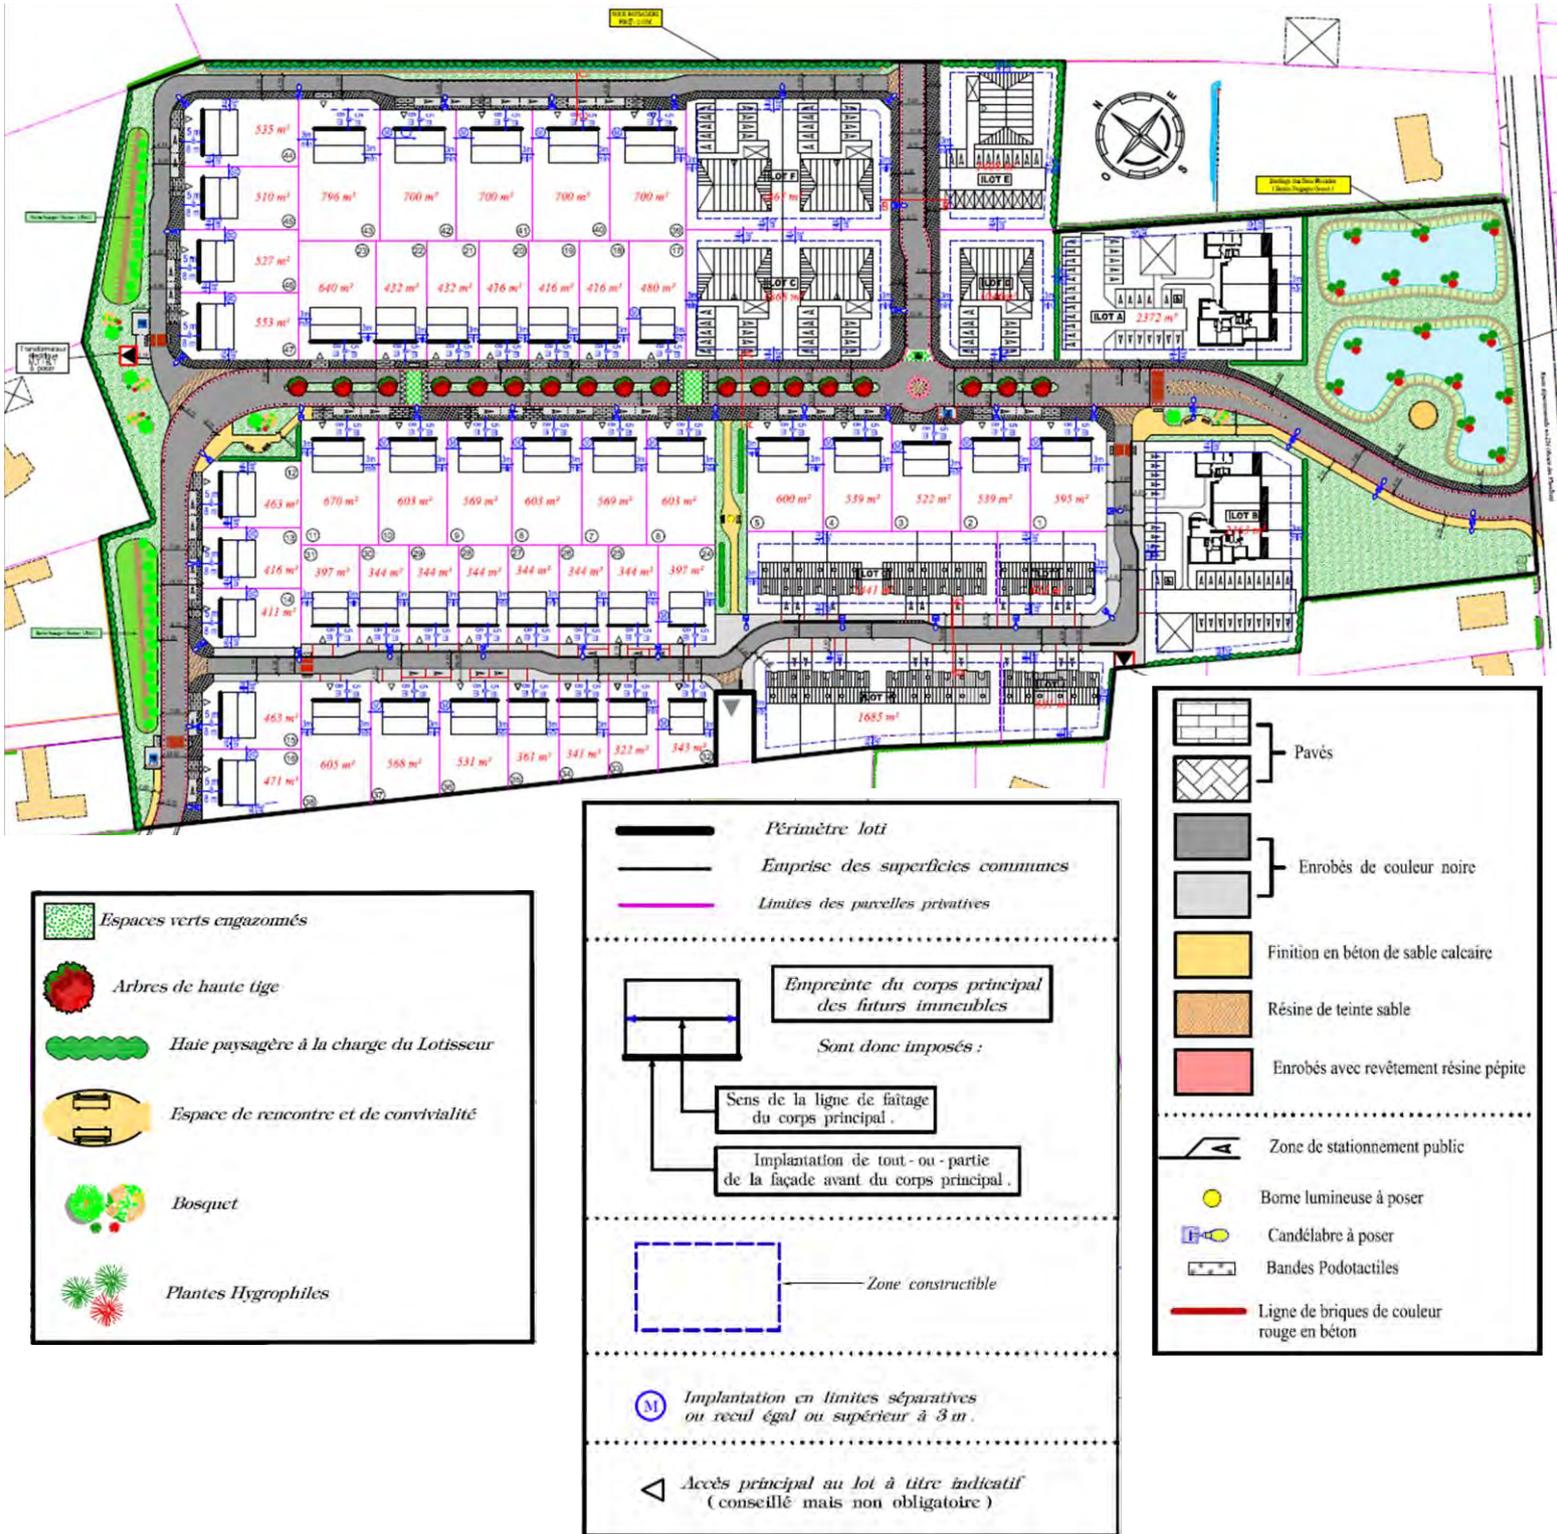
PLAN DE MASSE DU PROJET D'AMENAGEMENT (2021)
